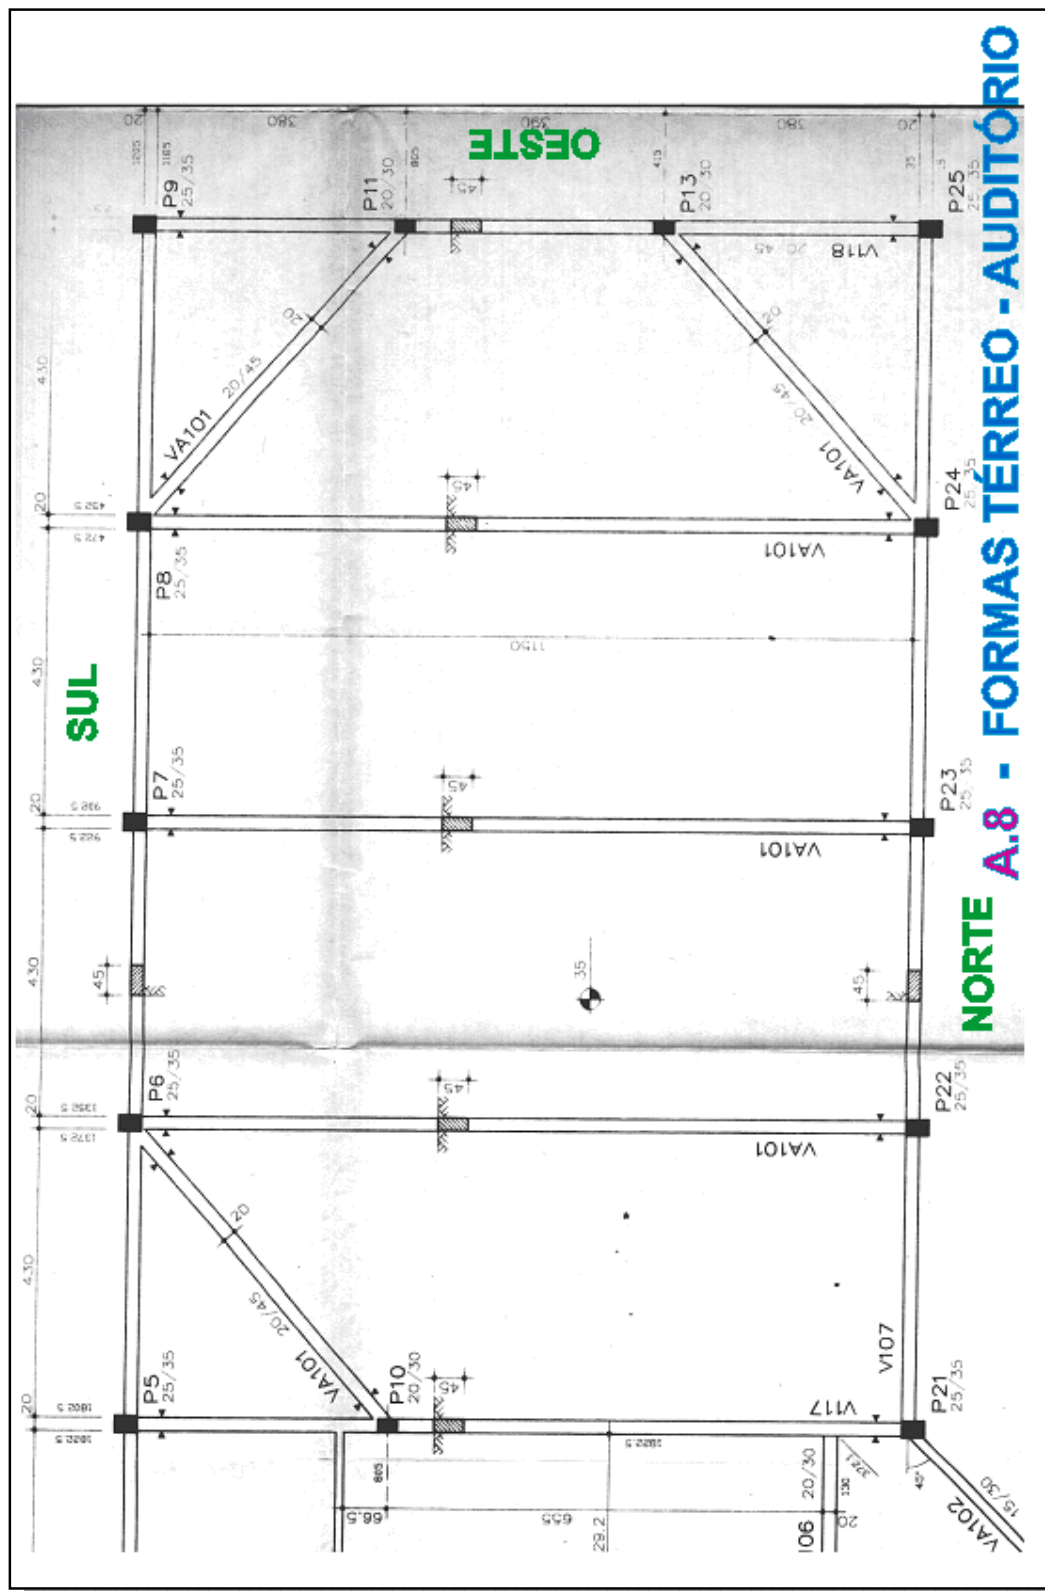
Planta de formas pavimento térreo setor Auditório (ISAIA, 2001, p. 39)
